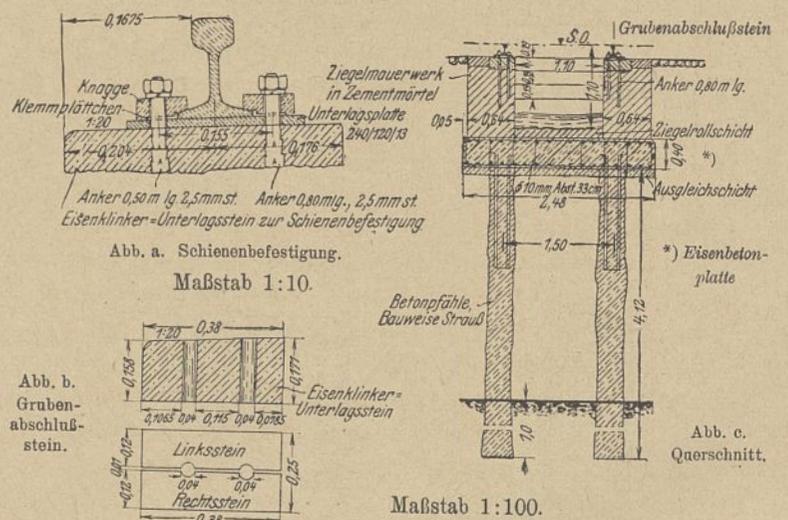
Nachträglich vor Heizhaus Nord eingebaute Löschgrube.
